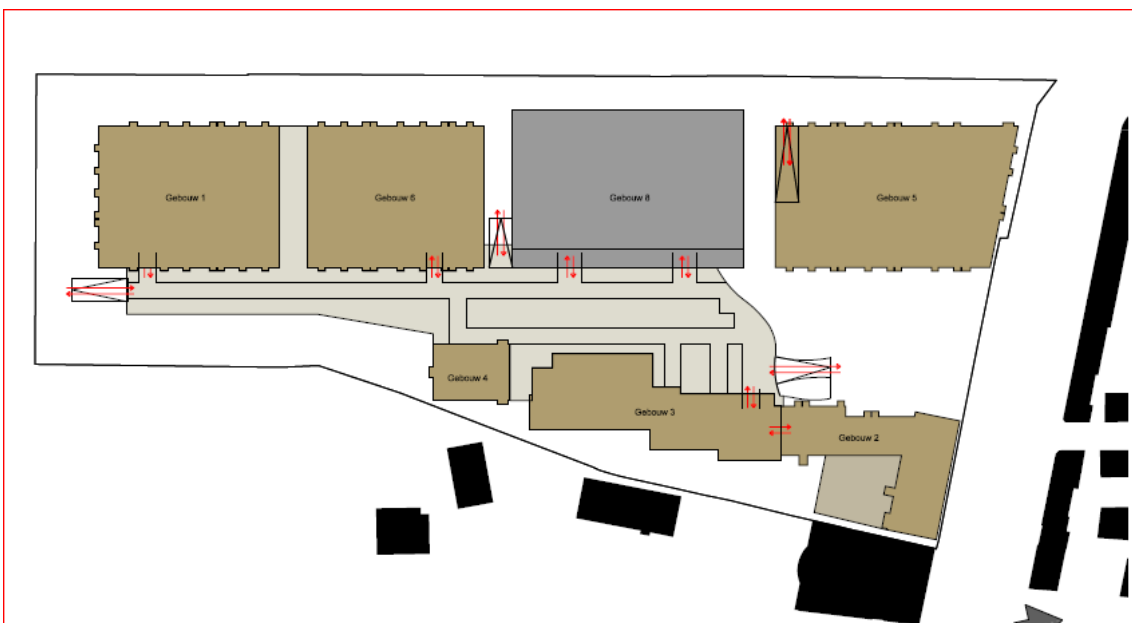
Stedenbouwkundigplan Plaza West (bron: Stedenbouwkundig plan (september 2016))
